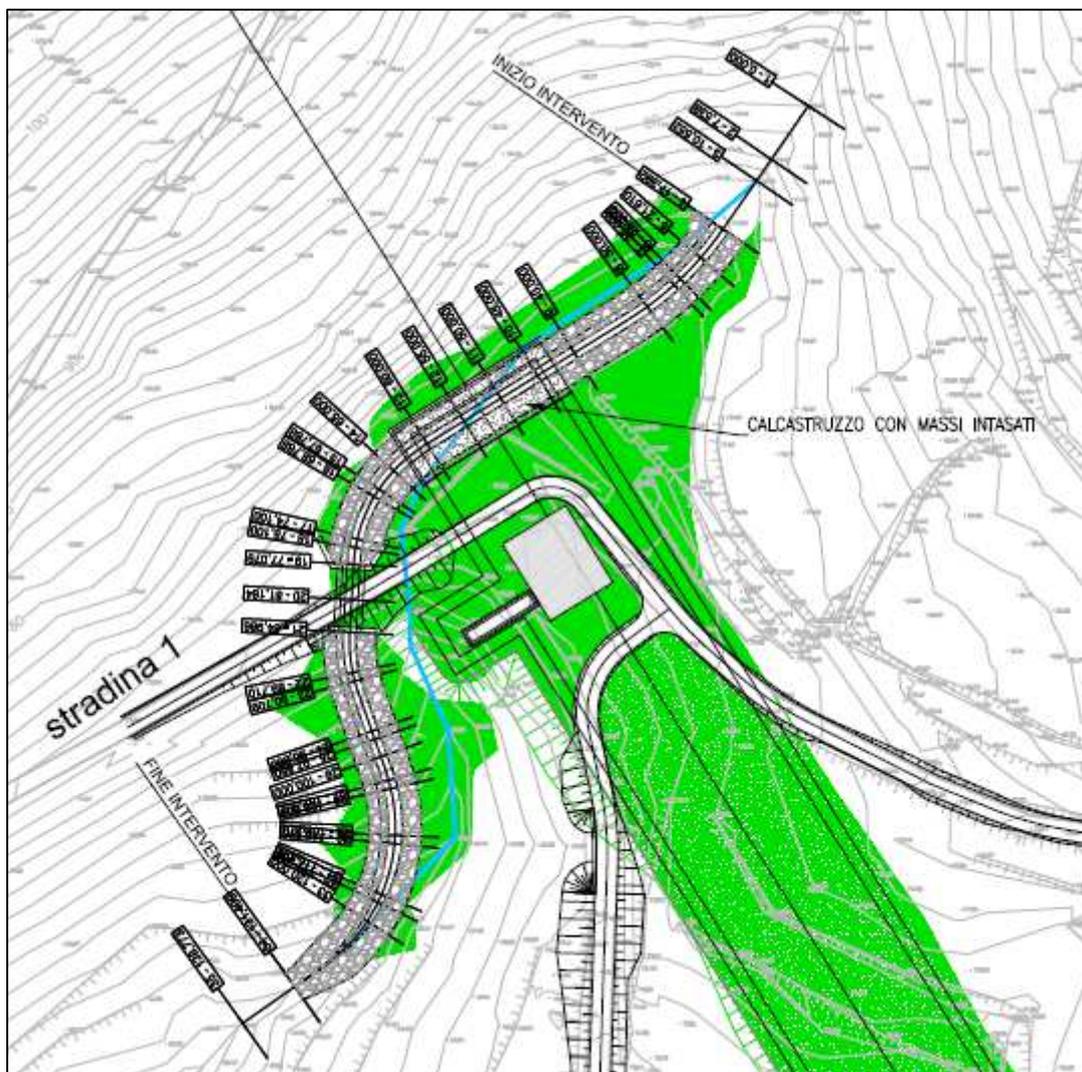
Planimetria inalveazione prog 2+309.74
